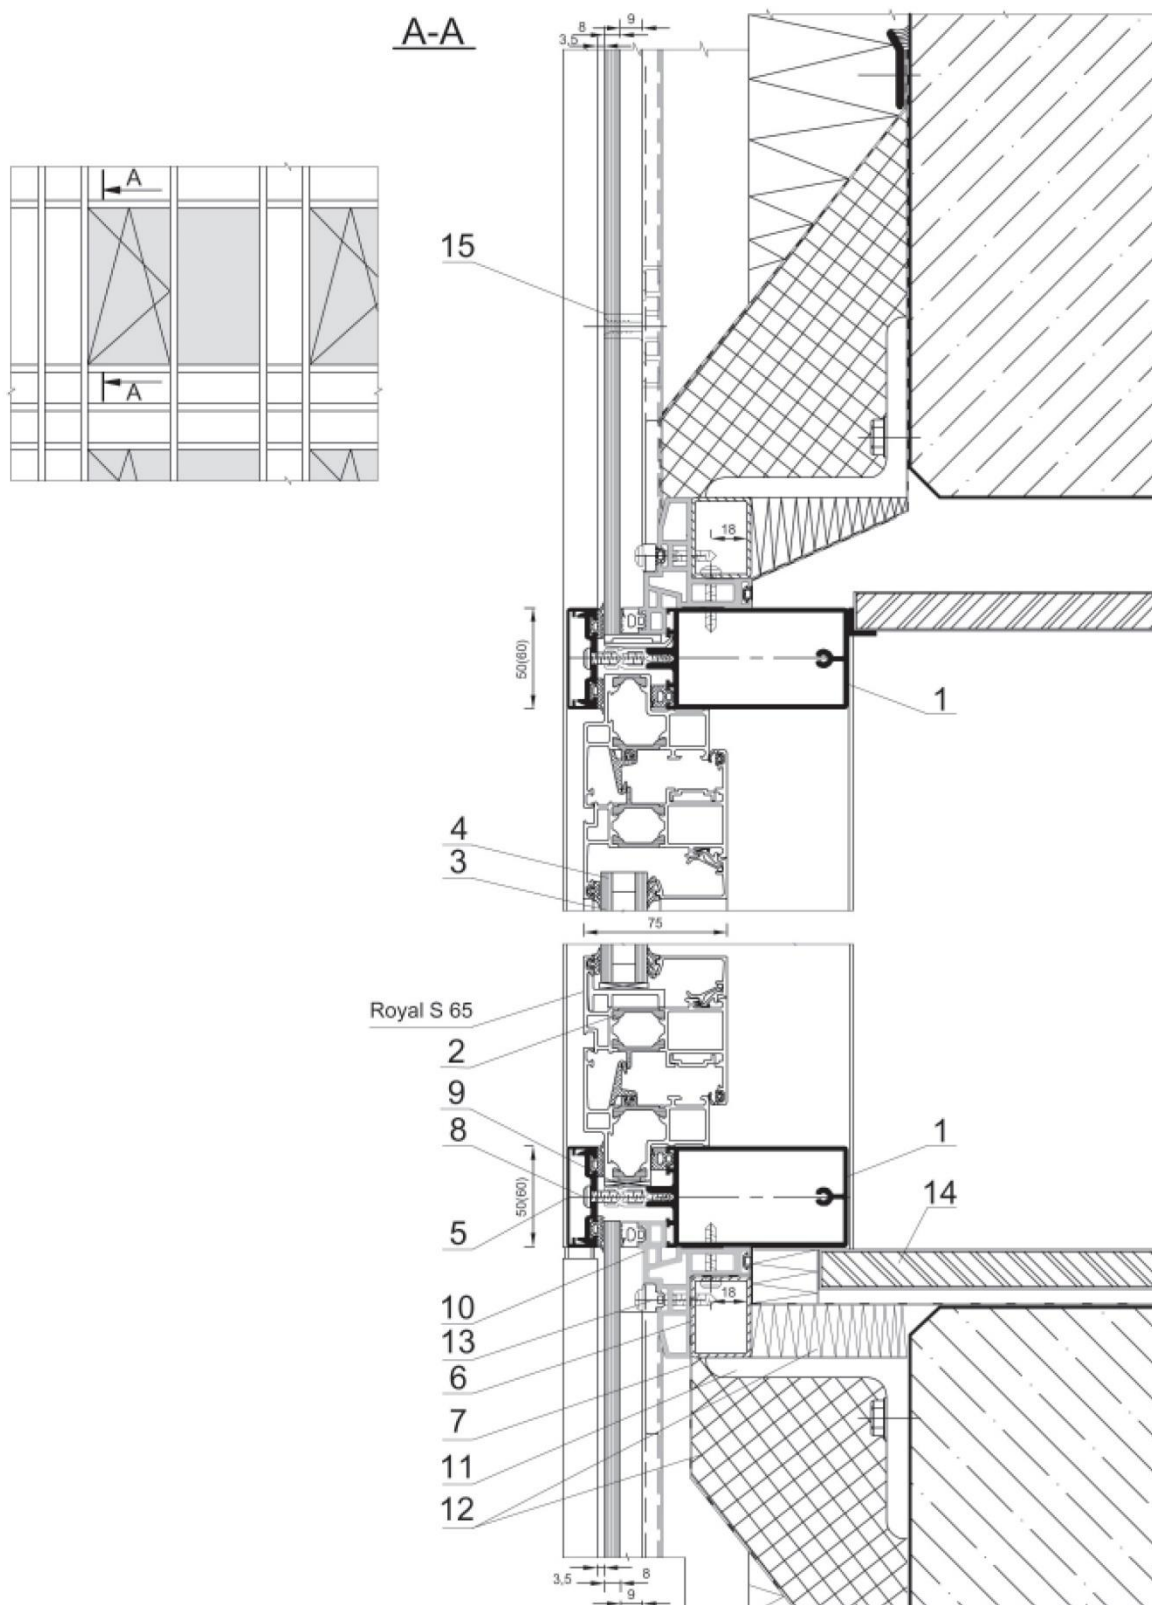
Стійково-ригельна фасадна ситема “тепло-холод” [9]
